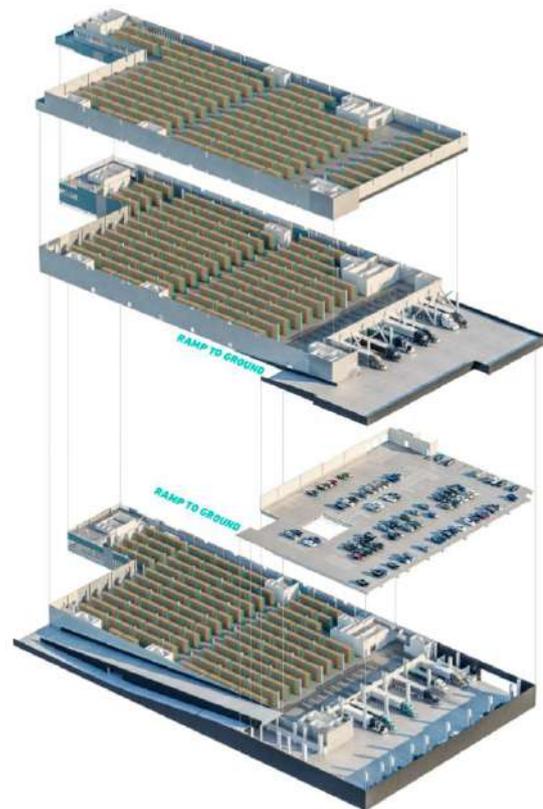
Plan d'entrepôt du "640 Columbia Street"
